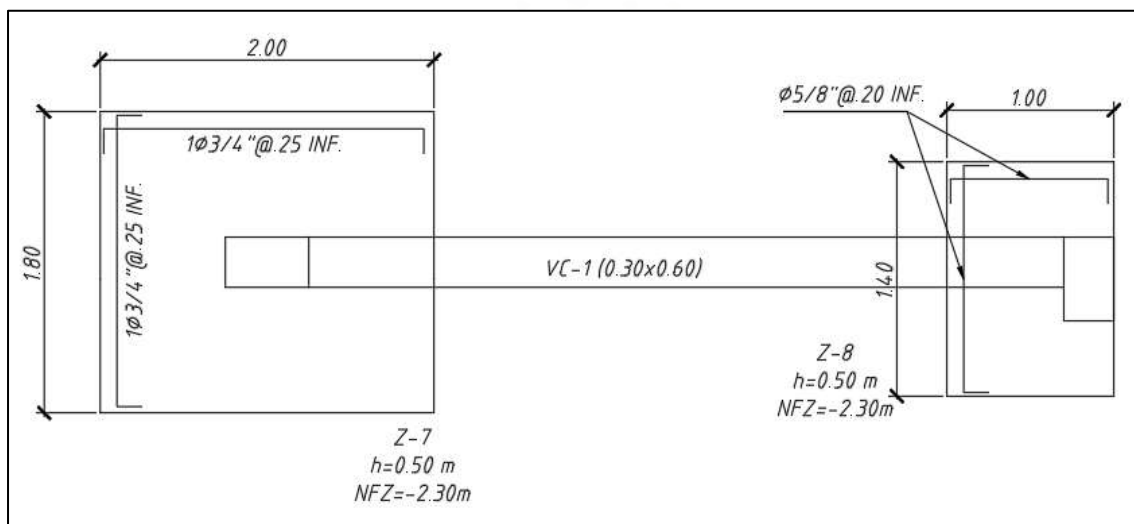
Disposición de acero en las zapatas conectadas Z-7 y Z-8
